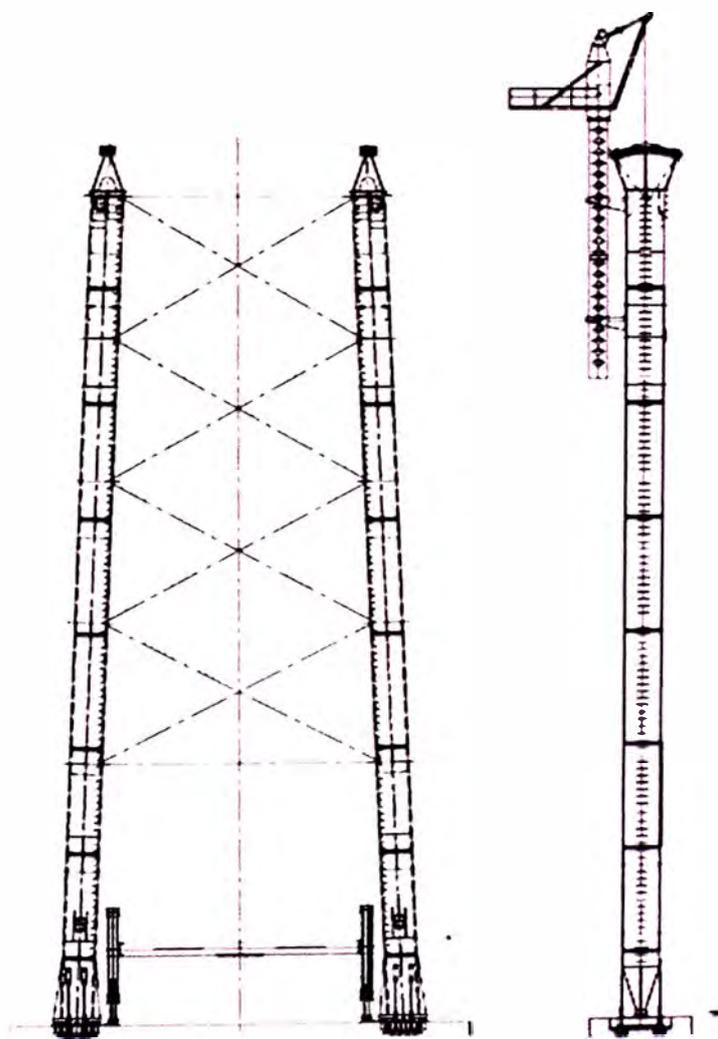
ESQUEMA FINAL DE MONTAJE DE PILONES
